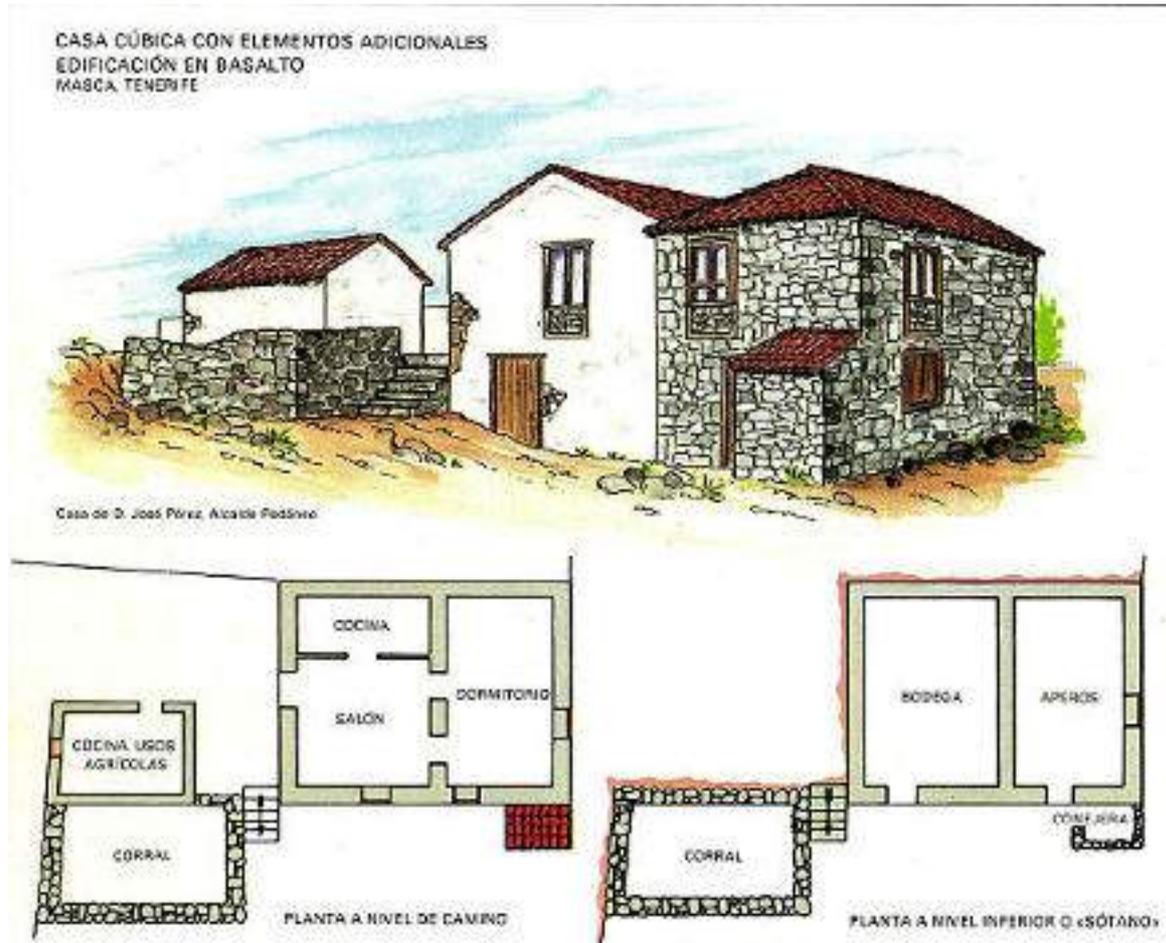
Vivienda de dos plantas con arrimo al terreno y espacios de servicio en planta baja. (Alemán de Armas 1985)
